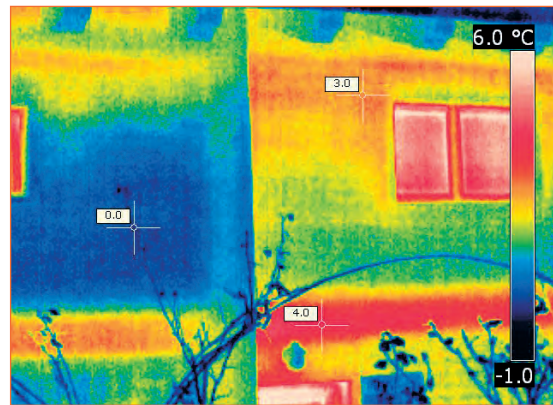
Intervento di isolamento dell'intercapedine all'interno del muro eseguito solo su una porzione di parete perimetrale
